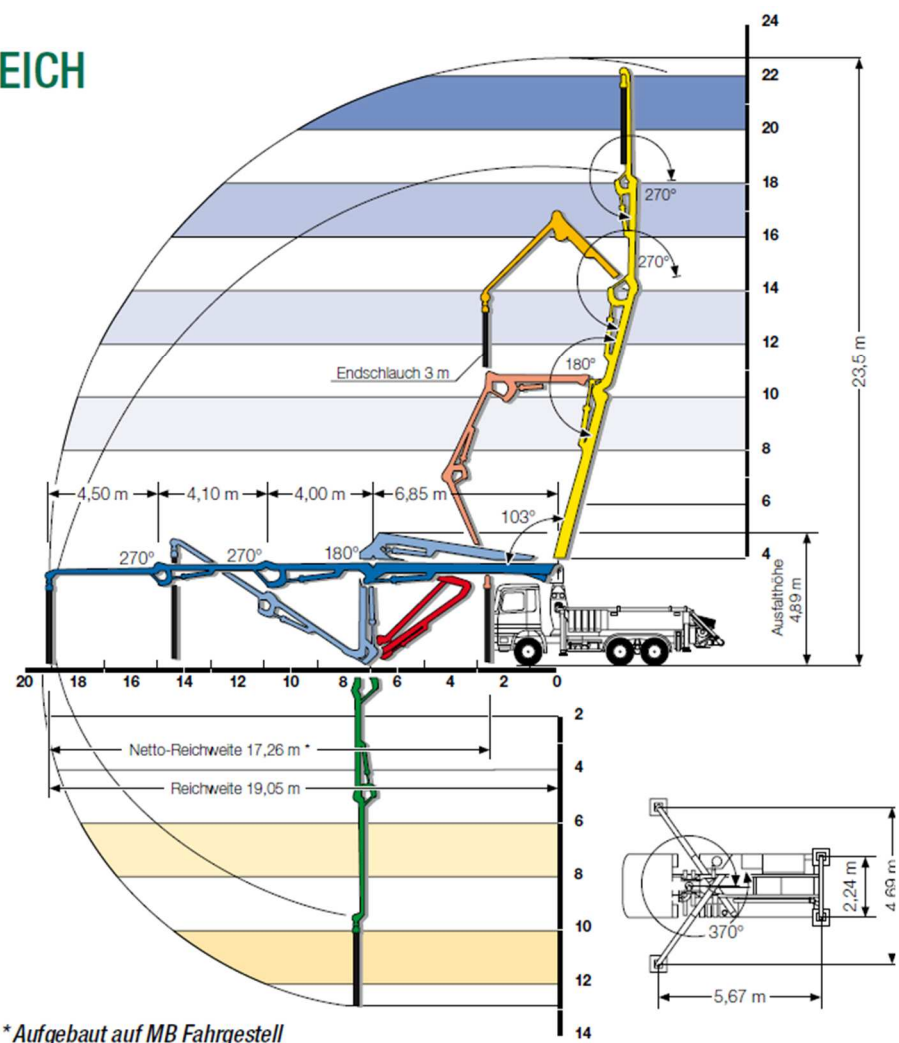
Technický list nákladního automobilu s hydraulickou rukou
